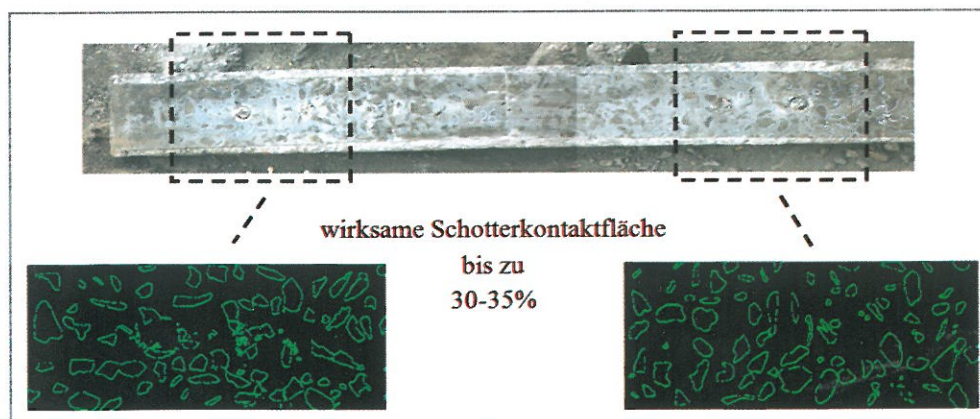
Digitale Kontaktflächenbestimmung an einer aus dem Betriebsgleis ausgebauten Betonschwelle mit PUR-Schwellenbesohlung (Porescan-Methode)
